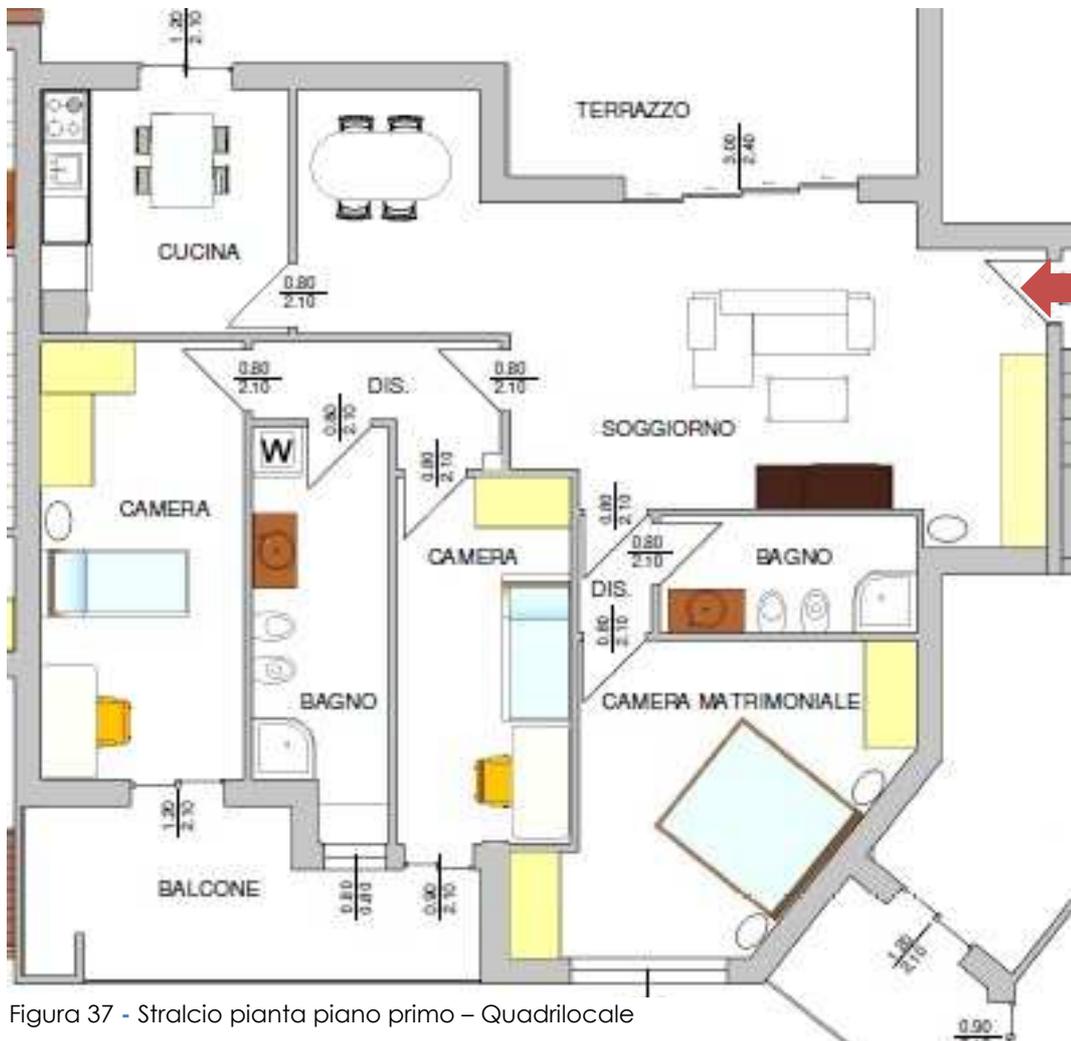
Stralcio pianta piano primo - Quadrilocale
